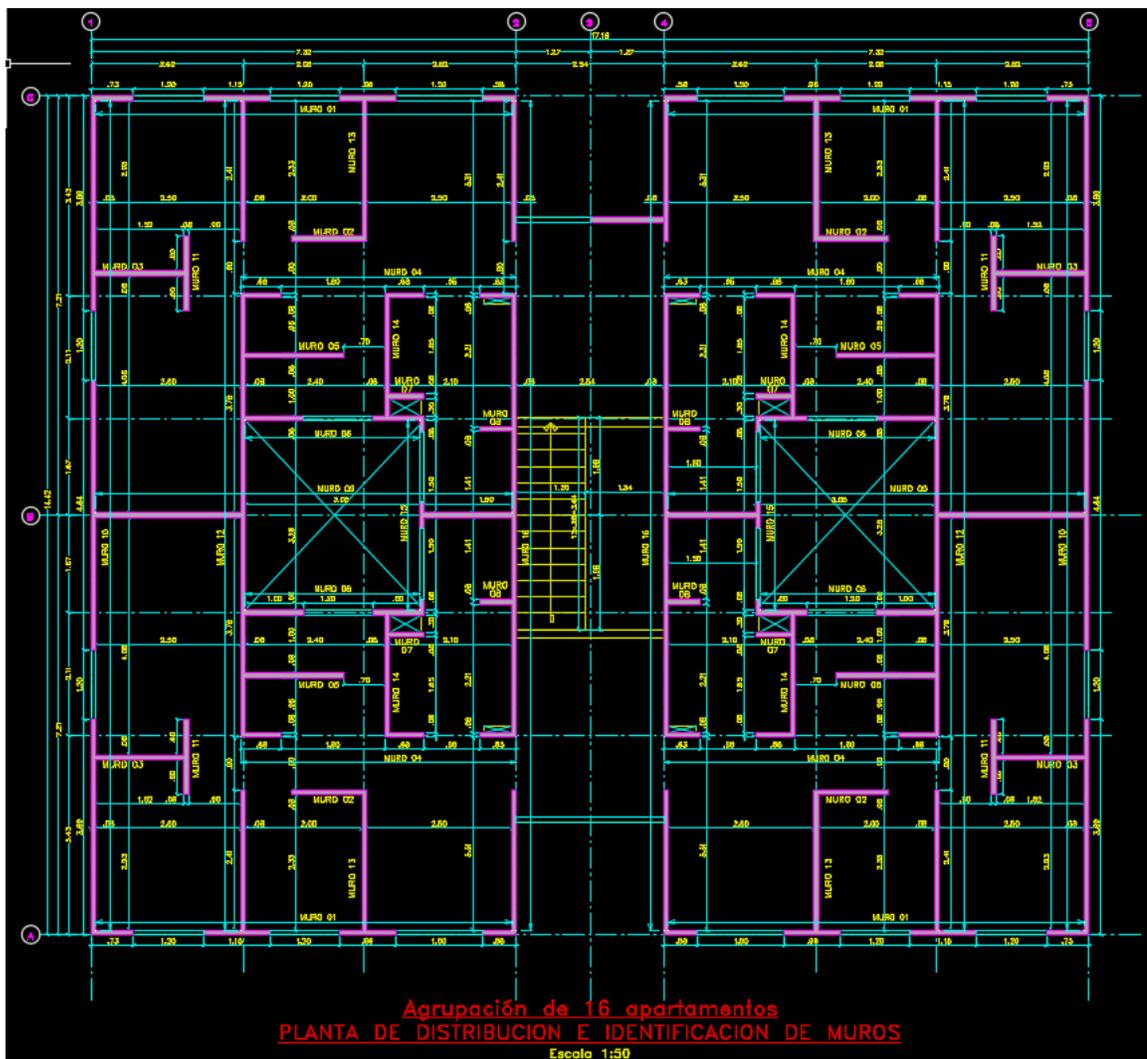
Plano de distribución e identificación de muros (Fuente: Occiviles S.A)
